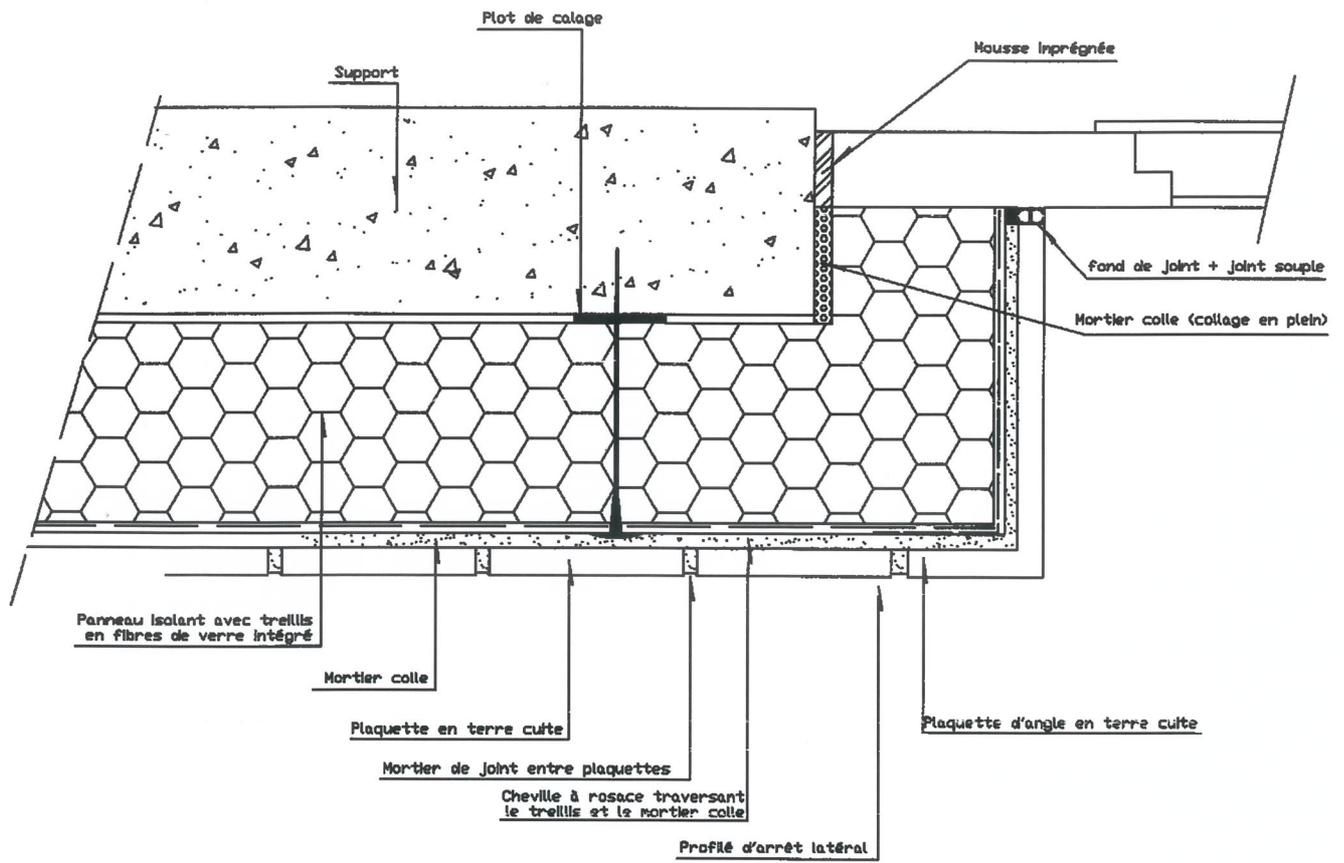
Arrêt sur menuiserie (coupe horizontale)
